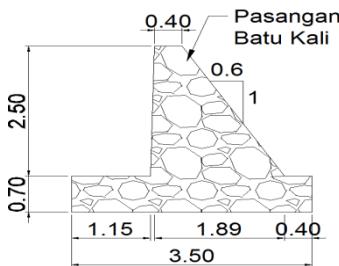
Detail *revetment* alternatif I di hulu pada cross section A12
